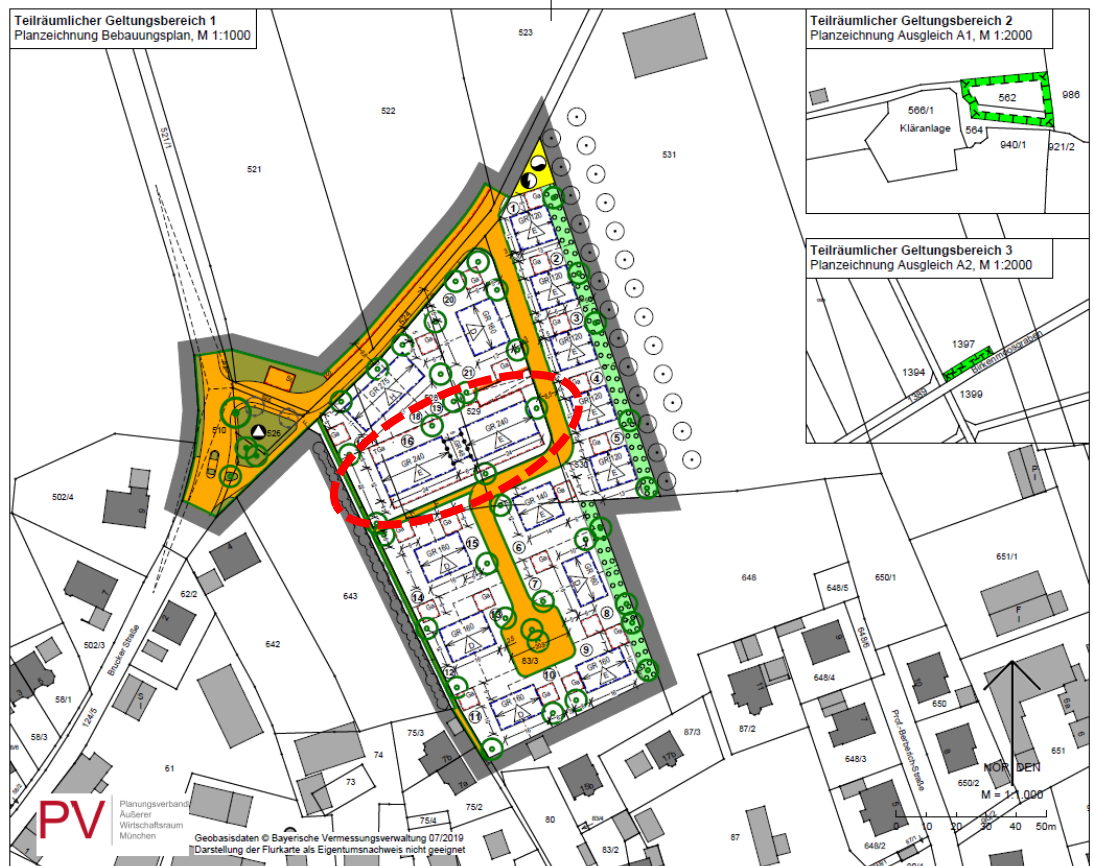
Ur-Plan „Biburg Nord“ (2024) mit Ausgleichsflächen, mit Markierung Plangebiet 1. Änderung (rot)
